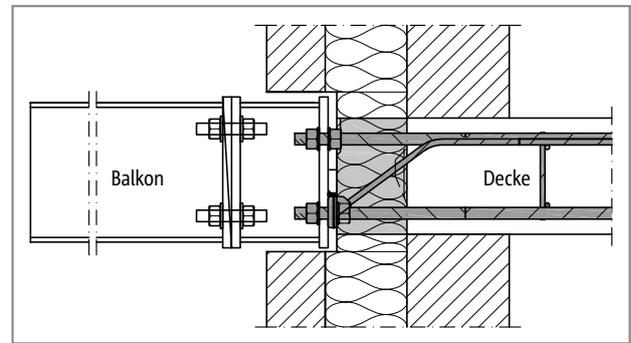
Schöck Isokorb® XT Typ SK: Dämmkörper innerhalb der Kerndämmung; bauseitiges Verbindungsstück zwischen dem Isokorb® und dem Balkon schafft Flexibilität im Bauablauf
